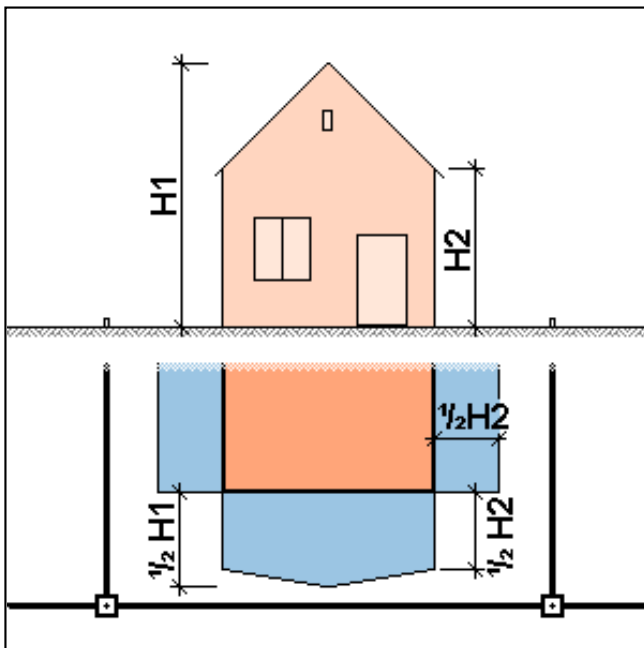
Obszar dopuszczalnego zasięgu przy spadku dachu
